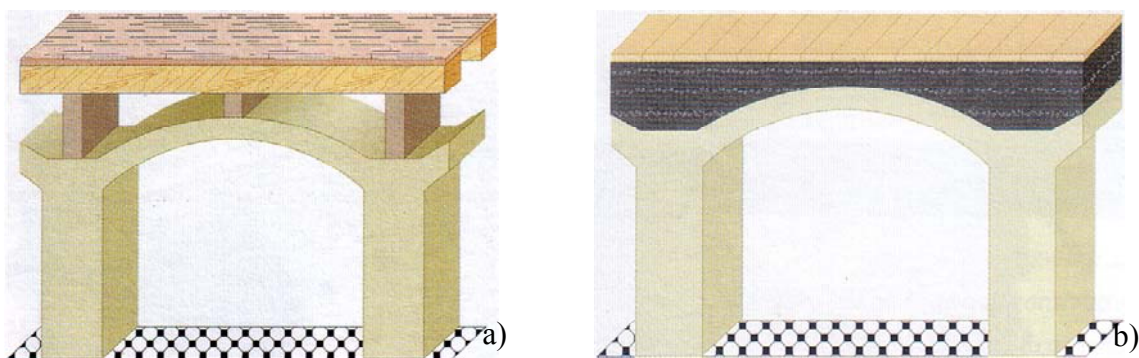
Pavimento em arcos com estrutura de madeira que recebe soalho (a) e pavimento em arco com enchimento que recebe revestimento de pedra ou cerâmico (b) (Appleton, 2003)
